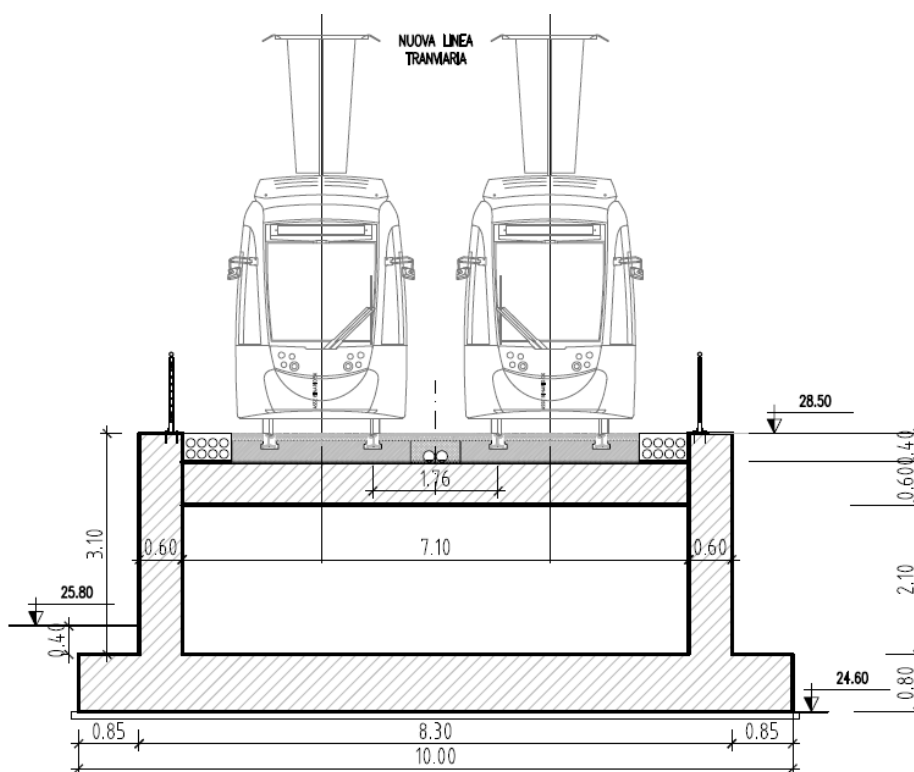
Sezione trasversale muro ad “U” terminale della linea
